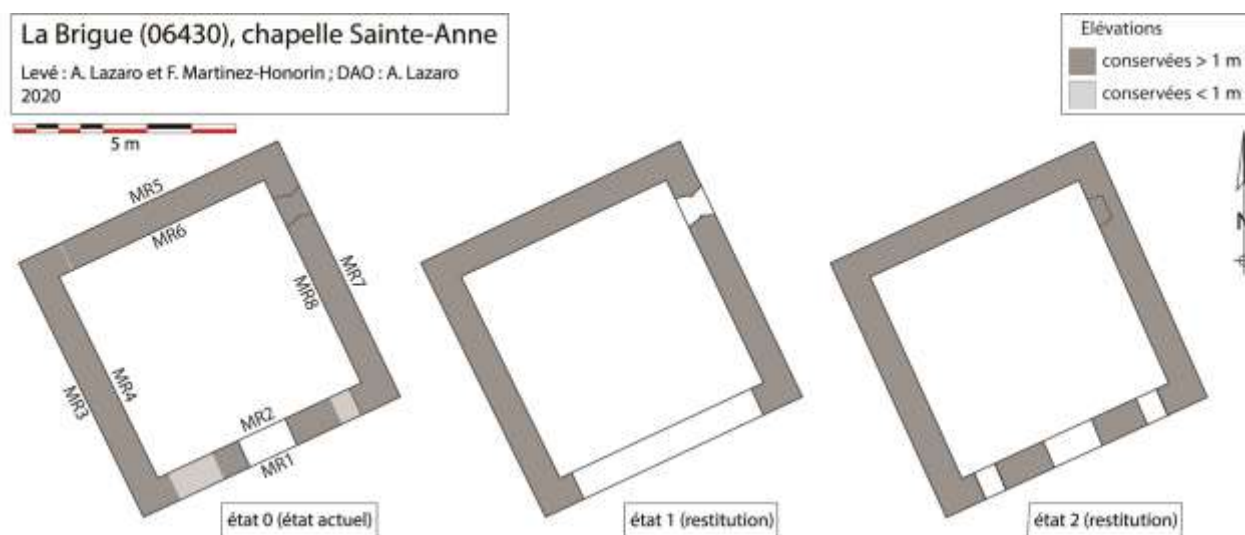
Plan de la chapelle, état actuel (ou état 0), état 1 et état 2
